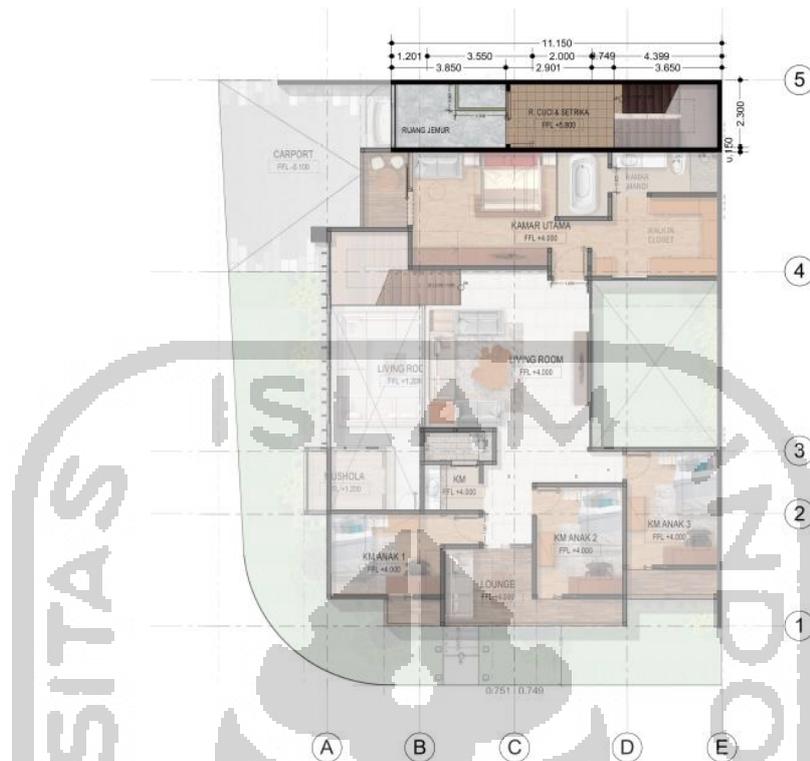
Denah Lantai Satu Rumah Tinggal Ibu Nadya
